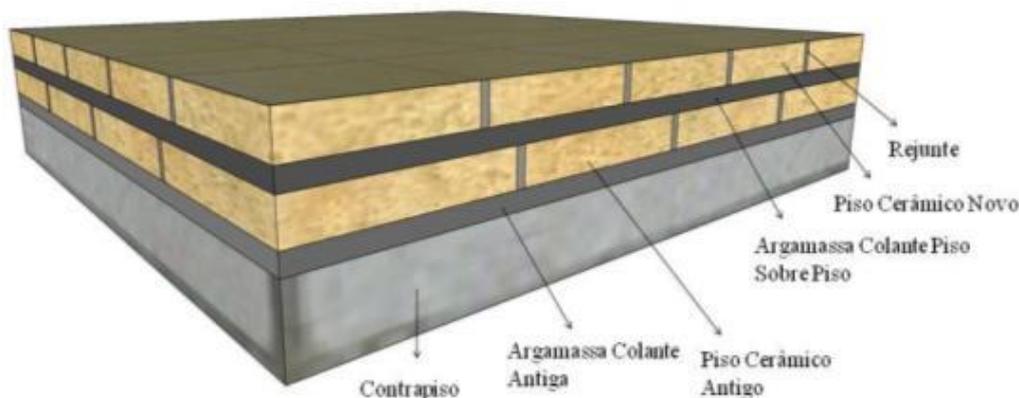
Sistema de revestimento cerâmico assentado de piso sobre piso.
